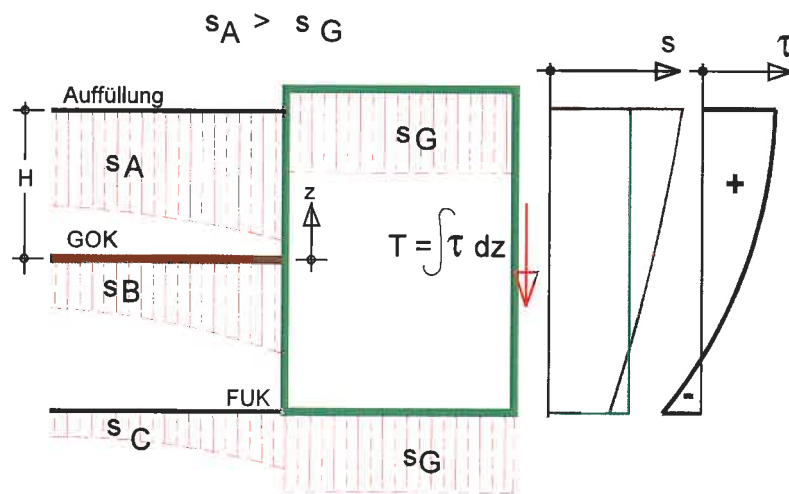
Belastung des Bauwerks aus Geländeauffüllung
